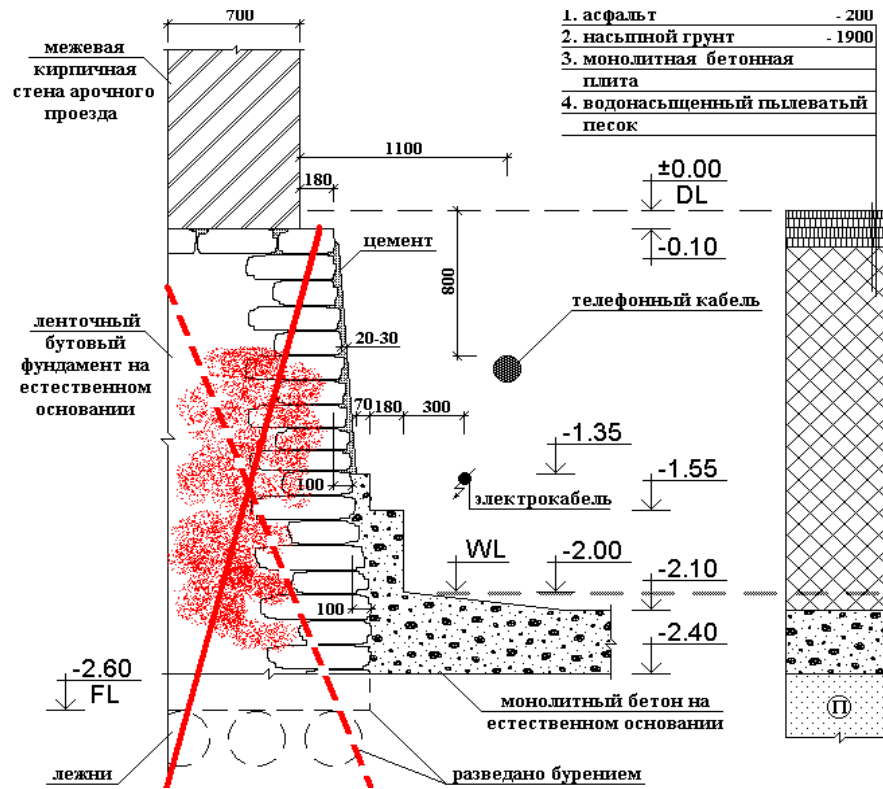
Схема – этап проведения инъекционных работ по усилению тела бутового фундамента со стороны фасада здания
